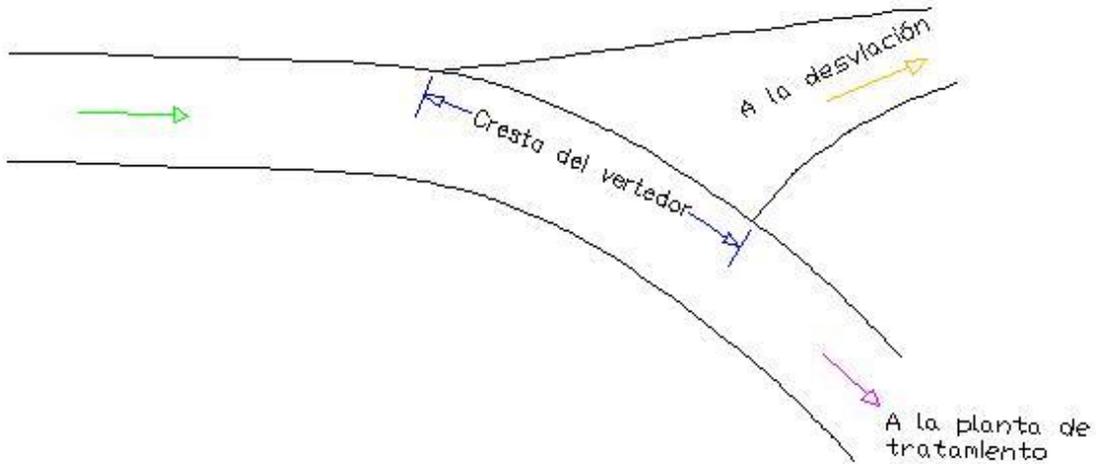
VISTA EN PLANTA DE UN VERTEDOR LATERAL.
